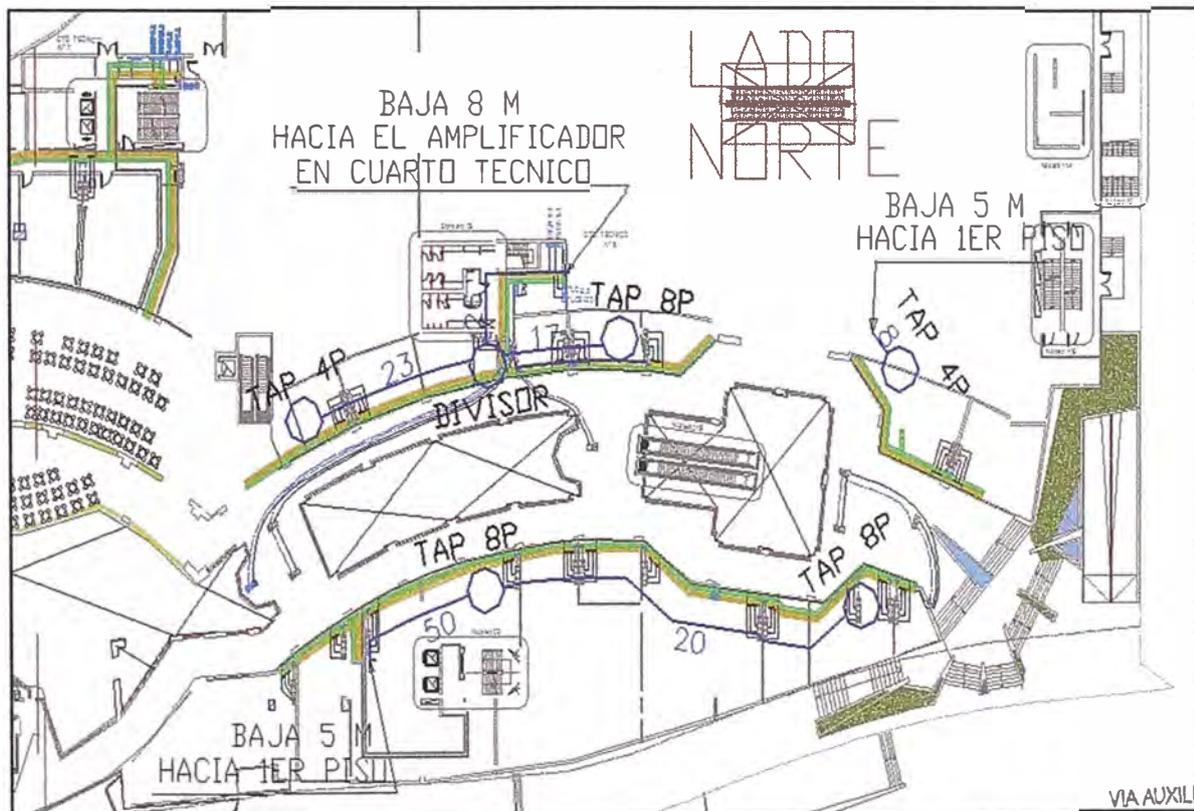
Planta alta, sector norte del C.C. Comercial Parque Lambramani. Fuente: Elaboración propia.
